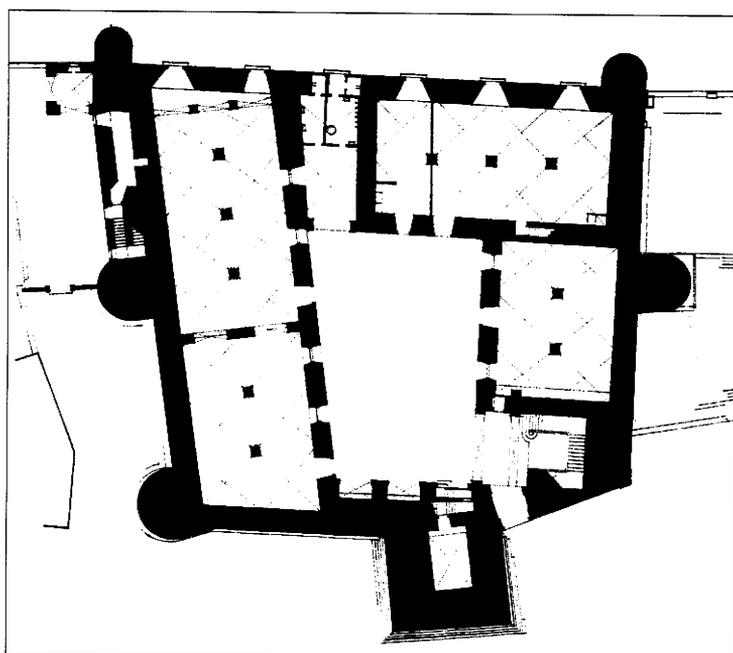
Planta do r/c antes das obras de adaptação a pousada
